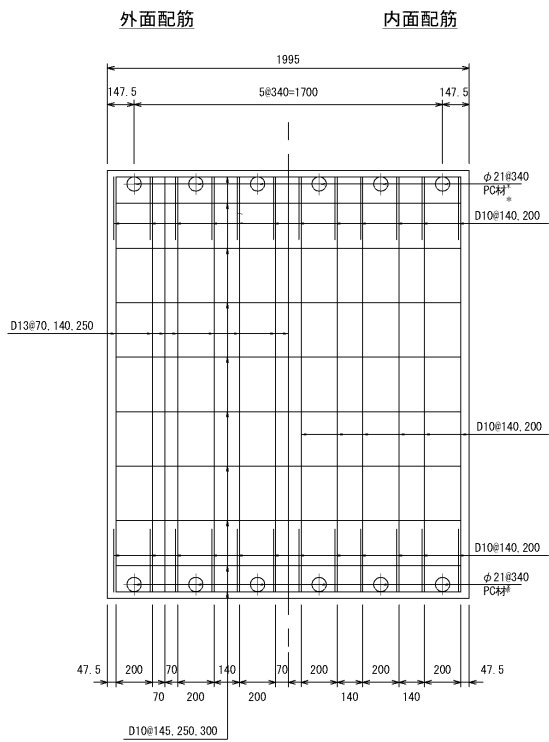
(1) 屋外排水路 (防波壁横断部) の概略配筋図
